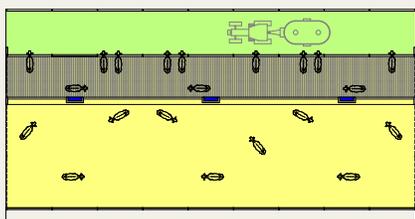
VUE EN PLAN DE 2 RANGÉES DE LOGETTES FACE À FACE CALLEBOTIS POUR VACHES LAITIÈRES
